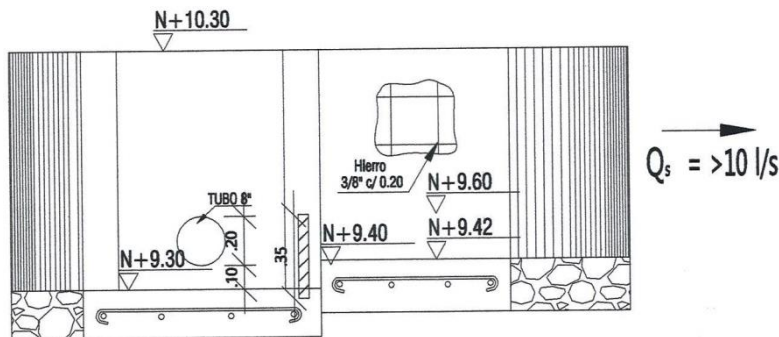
Detalles de la obra de captación, vista en corte longitudinal.
